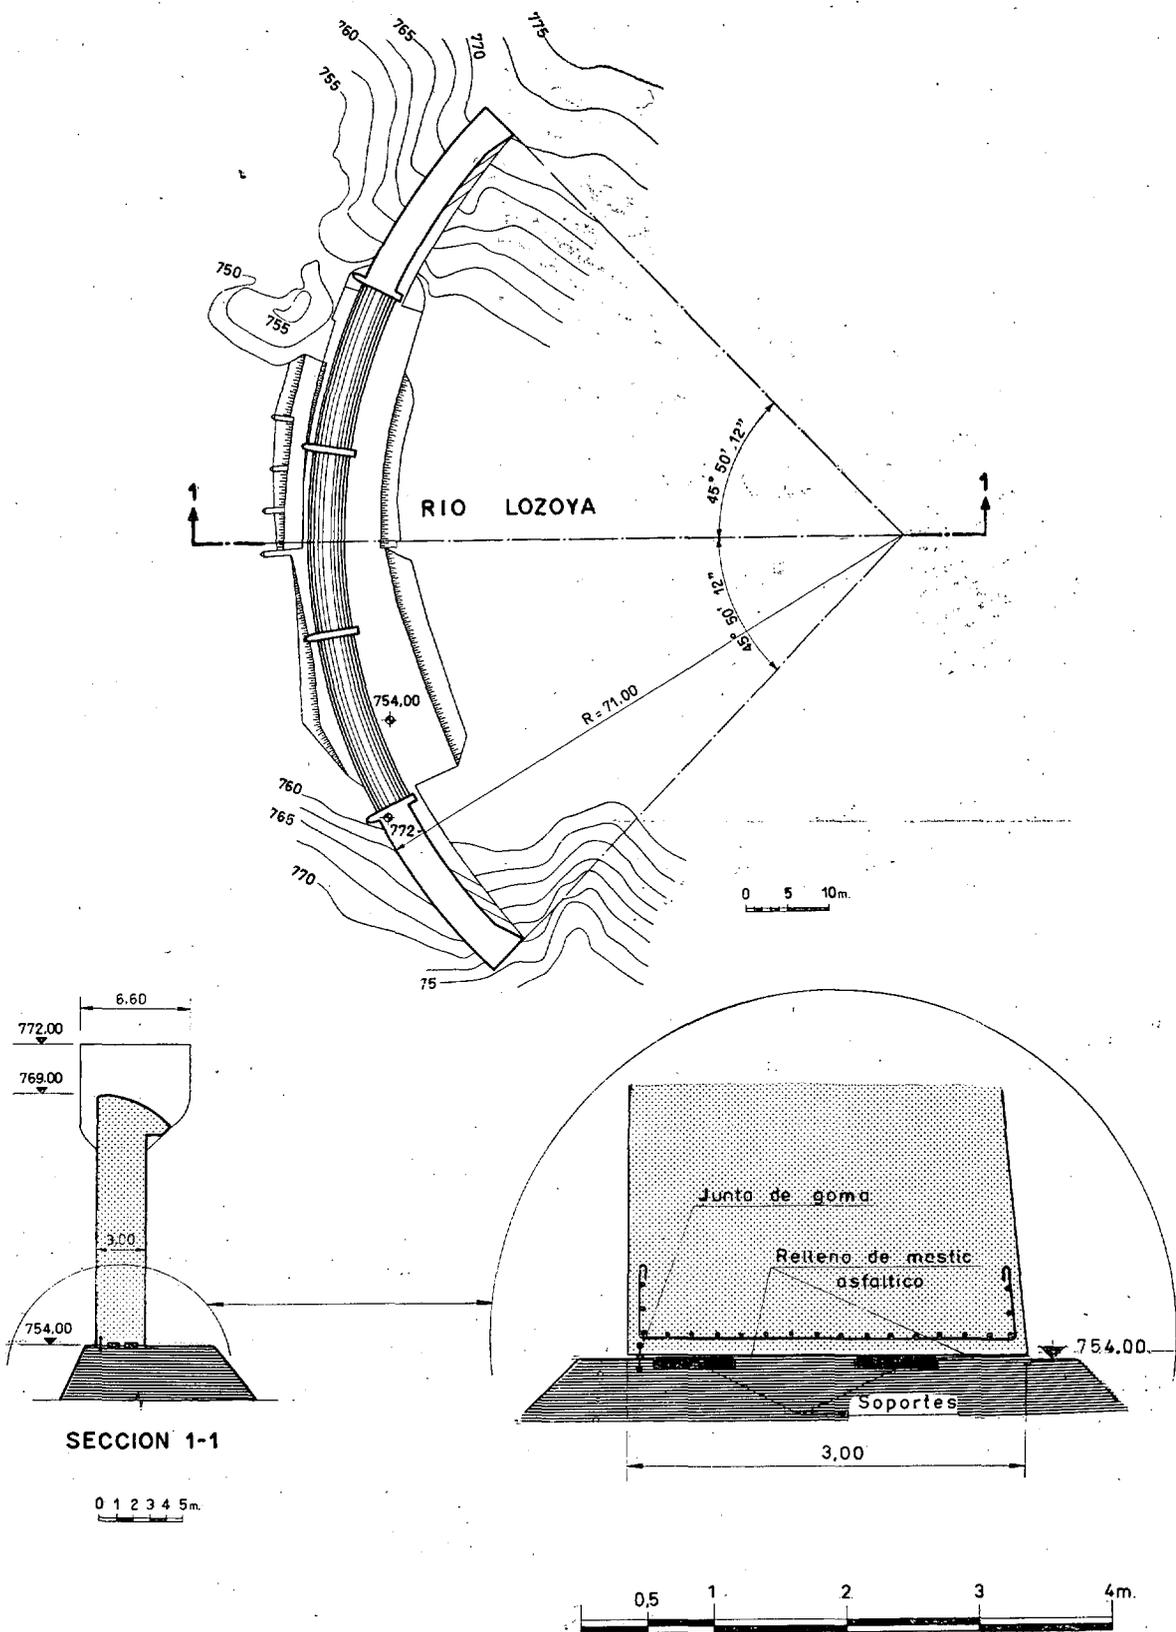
<sup>a</sup> — Planta y perfil tipo de la ataguía de Atazar.
